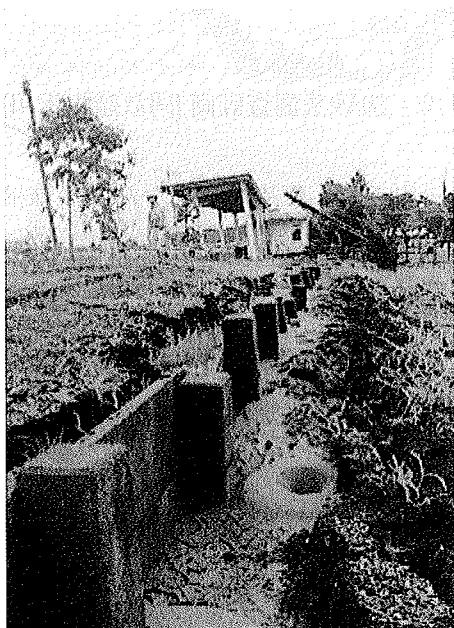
JR 越後線荒浜駅ホーム脇のコンクリート杭に沿つて現れた噴砂の跡。この噴砂を用いて液状化実験ボトル「エッキー」を作った。
